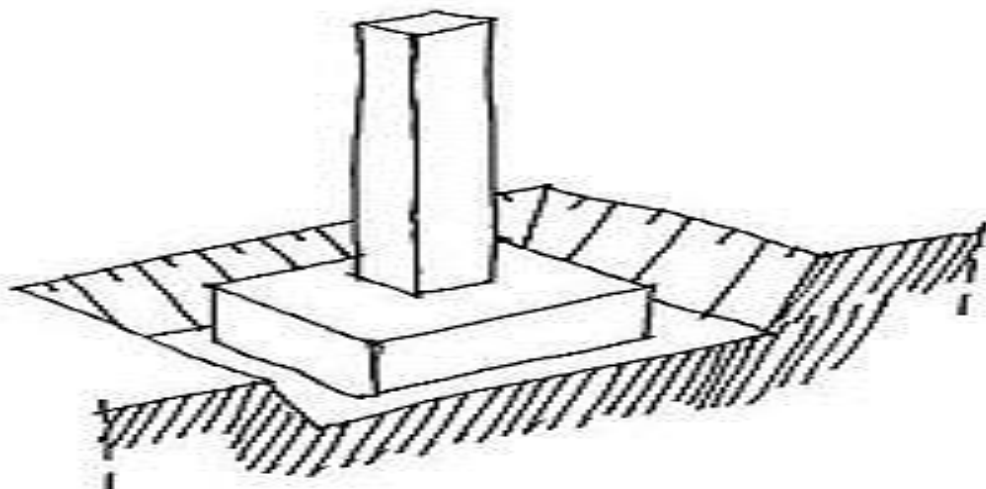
Fondation en semelle isolée (sous un poteau).
